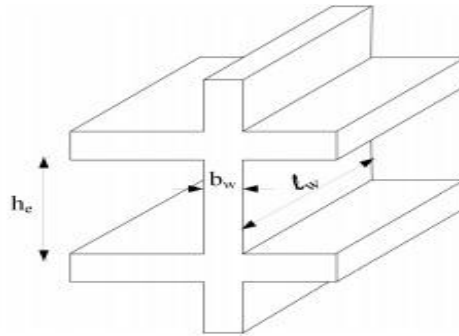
Spécifications pour les nœuds poteaux-poutres
